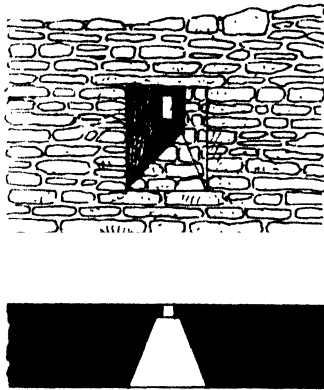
SPÉCIMEN DE FENÊTRE : PLAN ET ÉLEVATION.
